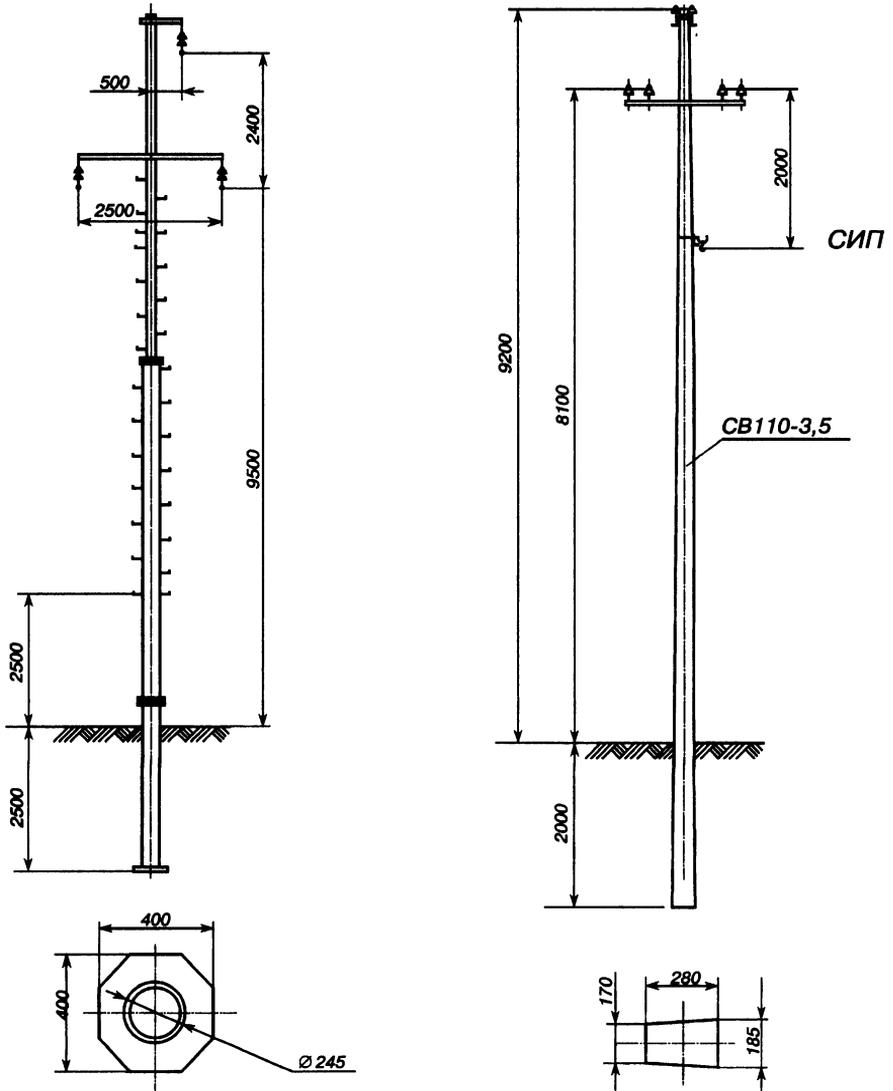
Железобетонно-металлическая опора ВЛ 10 кВ для потребителей первой категории
